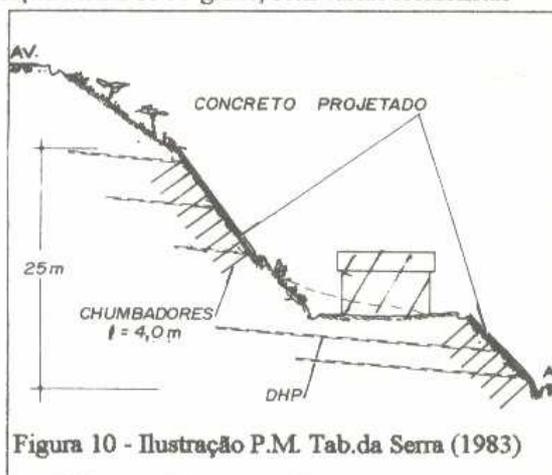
Ilustração P.M. Tab.da Serra (1983)
